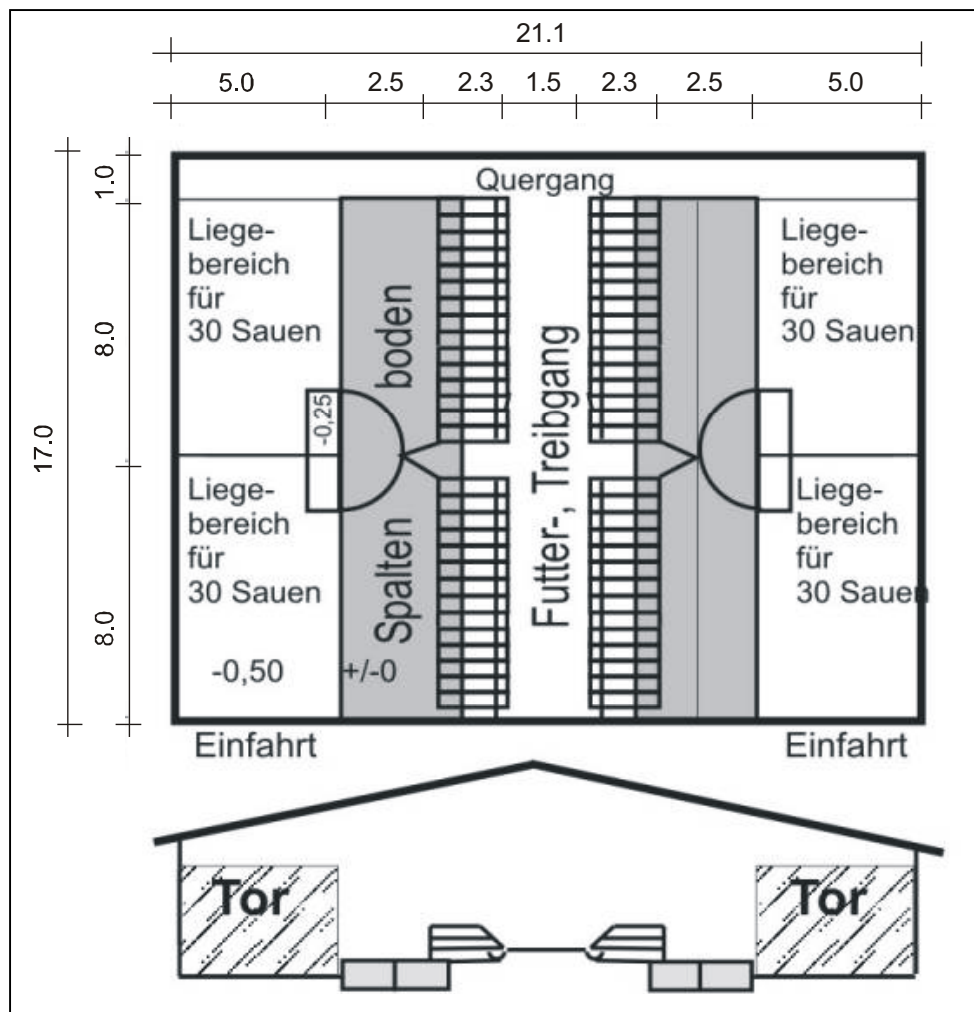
Grundriss- und Querschnitt einer Drei-Flächen-Bucht mit Cafeteriafütterung (in „Sauen in Gruppenhaltung“, KTBL-Schrift 411, 2002, S. 73)
